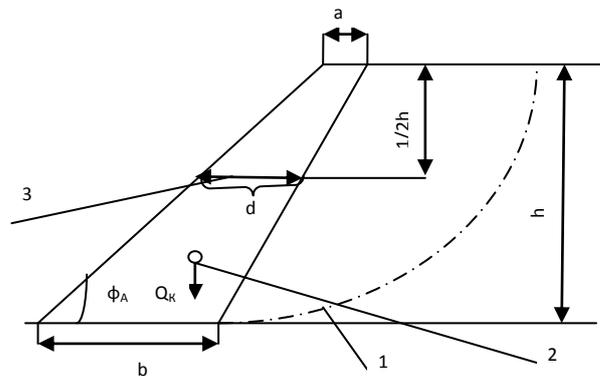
Поперечное сечение уступа, укрепленного контрфорсом: 1 - линия скольжения в уступе; 2 - центр тяжести контрфорса; 3 - средняя ширина контрфорса
